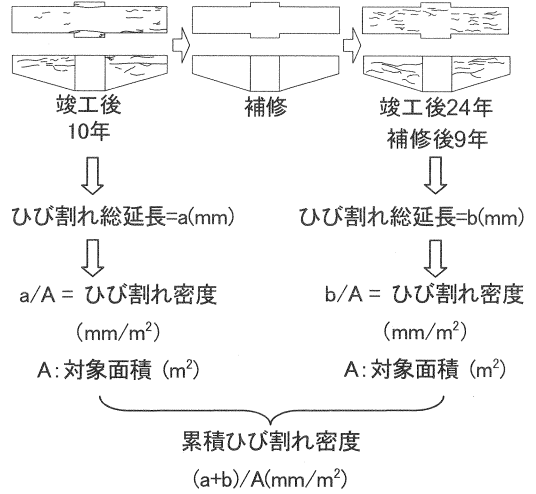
累積ひび割れ密度の算出例 (H橋脚)
